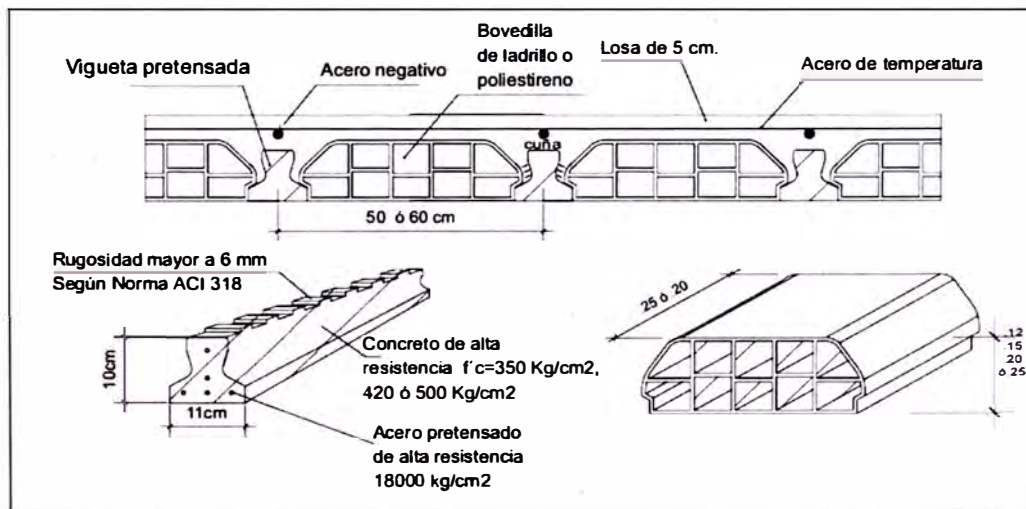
6 .-Detalle típico del sistema de viguetas pretensadas Firth
